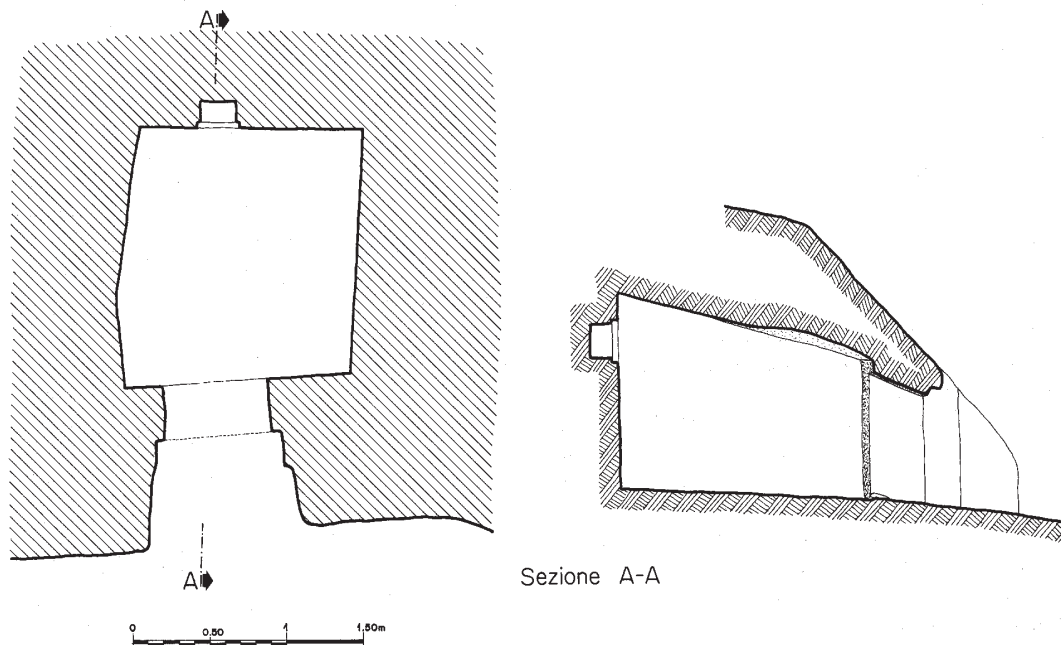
Bortigali, Domu I di Funtana Lada: pianta e sezione.
